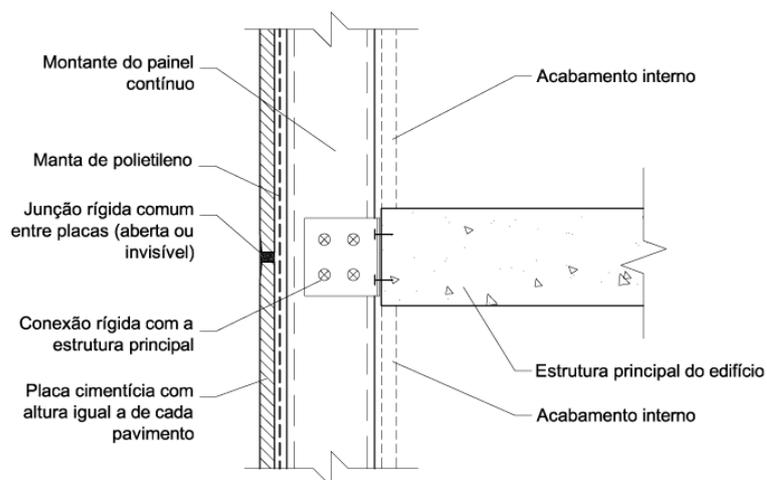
Painel contínuo com junta oculta em placa cimentícia sobre conexão rígida
